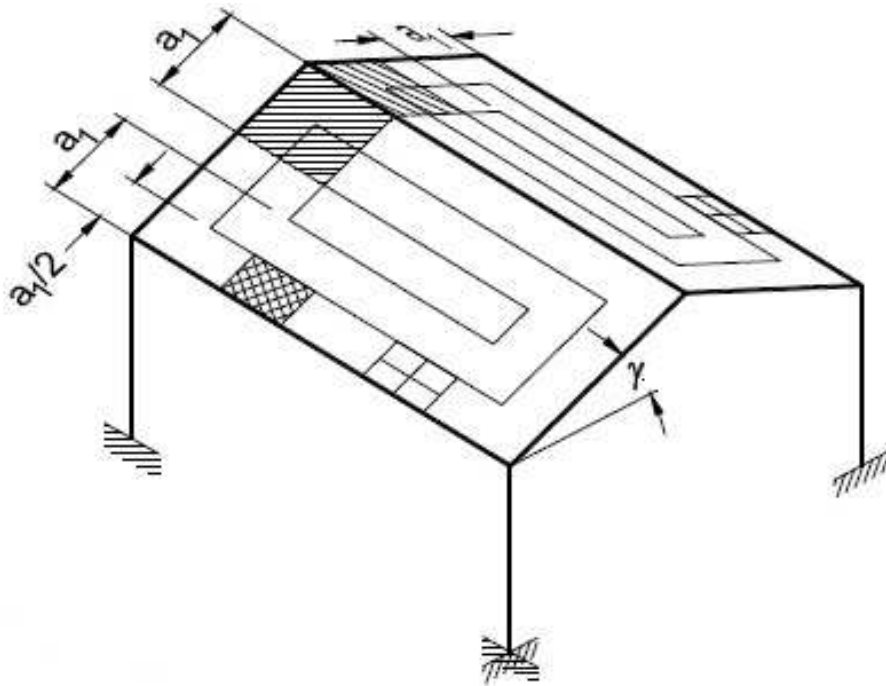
Estructura tipo techos aislados "cubiertas ligeras" (CFE, 2008b).
